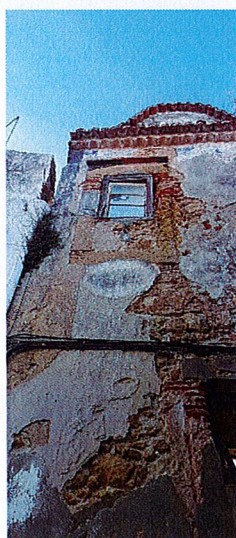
Ausência de reboco, destacamento, fissuração e desagregação do revestimento
